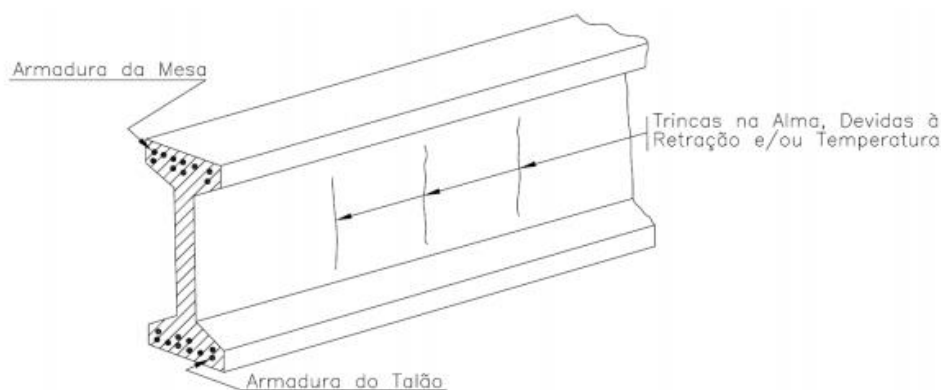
Fissuras e trincas na alma devidas à retração e/ou temperatura
